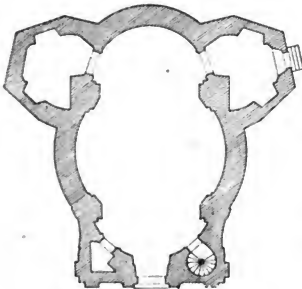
Pechin. Grundriss der Friedhofskirche.
